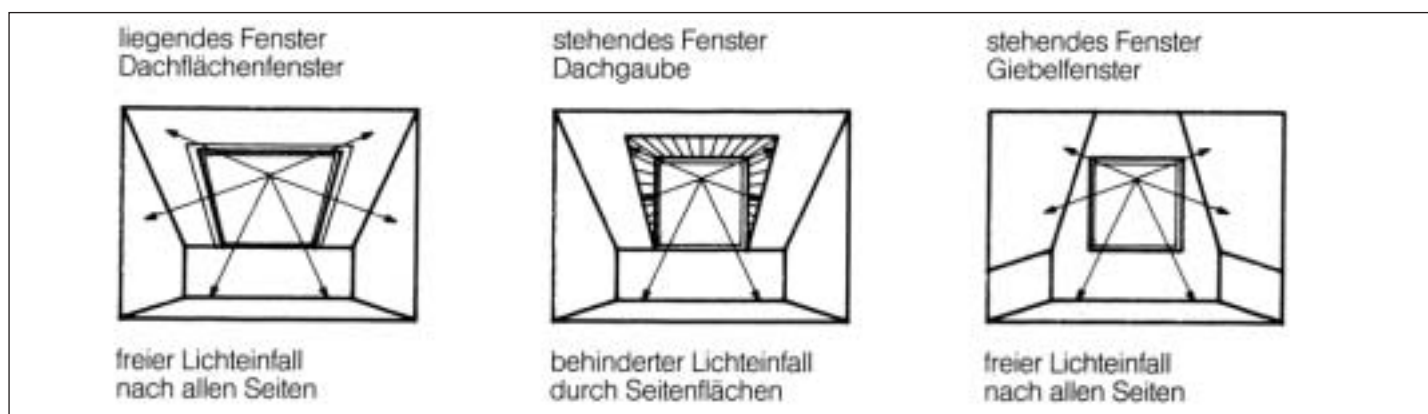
Lichteinfall bei Dachflächenfenster, Dachgaube und Giebelfenster
